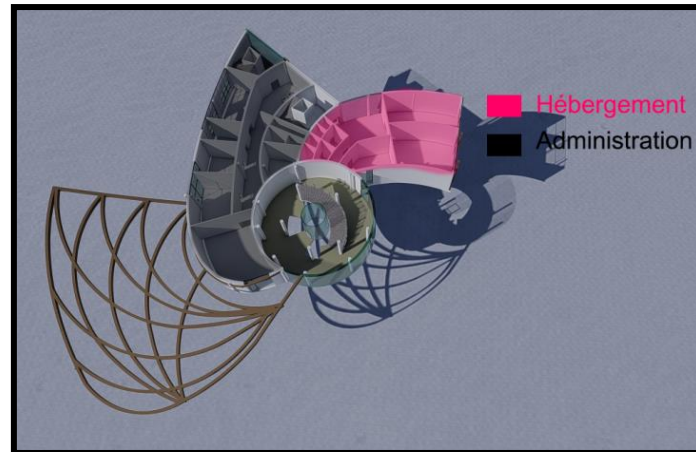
vus 3d de plan de 3^{eme} étage (auteur)
